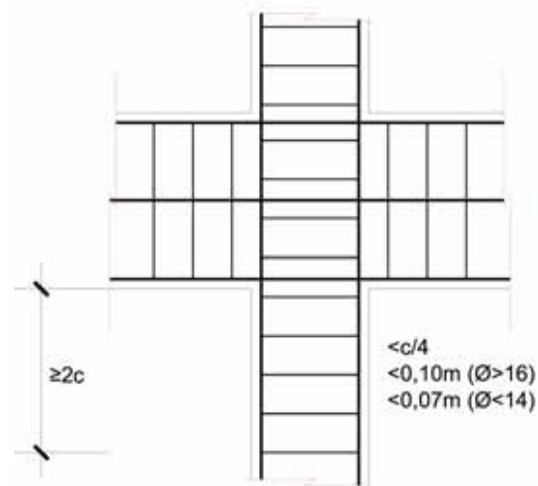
Detalle de confinamiento y armado de un pilar según la norma NCSE-02.
